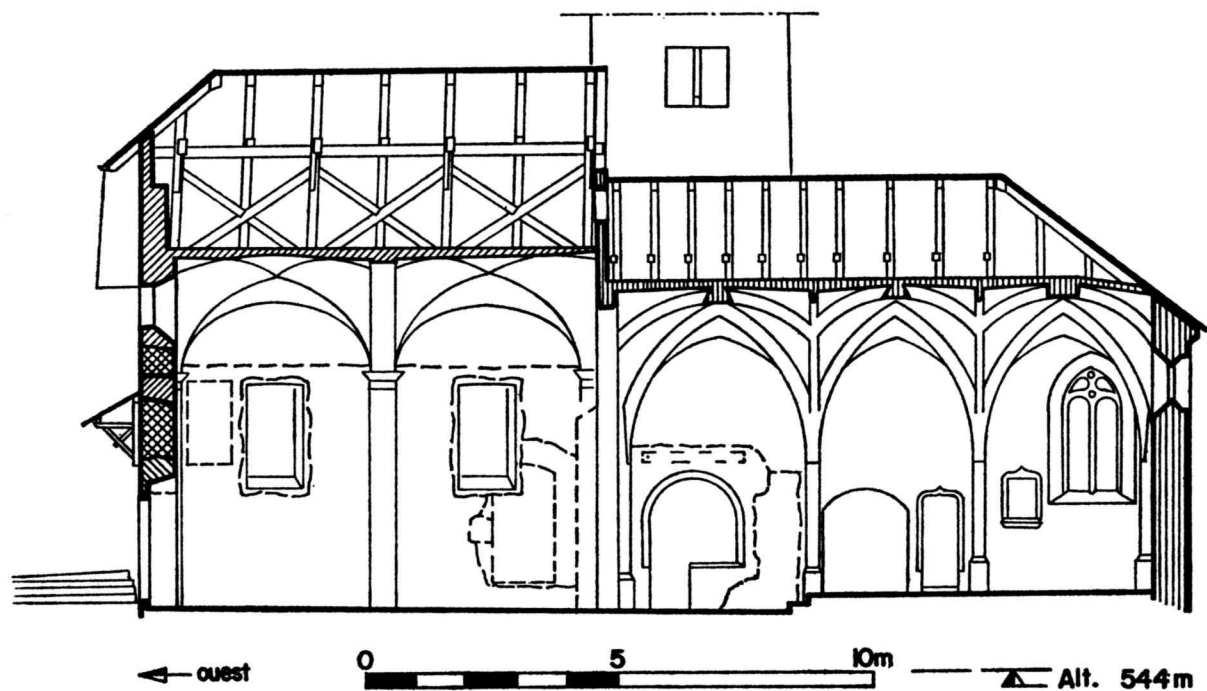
Profil longitudinal (avec élévation au nord ; sans le pilastre est de la nef, et sans le maître-autel).
